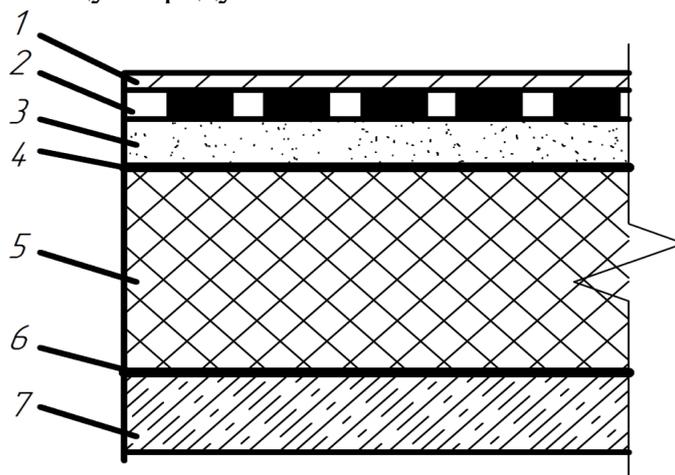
Устройство промышленного пола: 1 – покрытие пола («чистый» пол); 2 – гидроизоляция от производственных вод; 3 – подстилающий слой; 4 – гидроизоляция; 5 – теплоизоляция; 6 – гидроизоляция от грунтовых вод; 7 – бетонная подготовка или междуэтажное перекрытие
